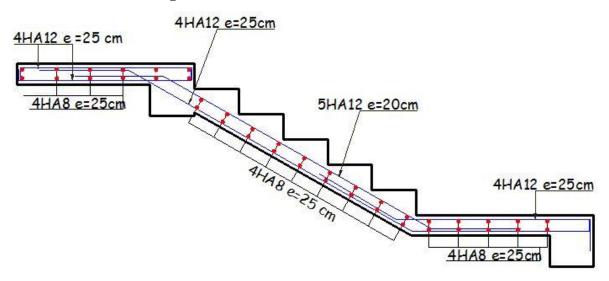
Schéma de ferraillage de la volée 1 et 3.
